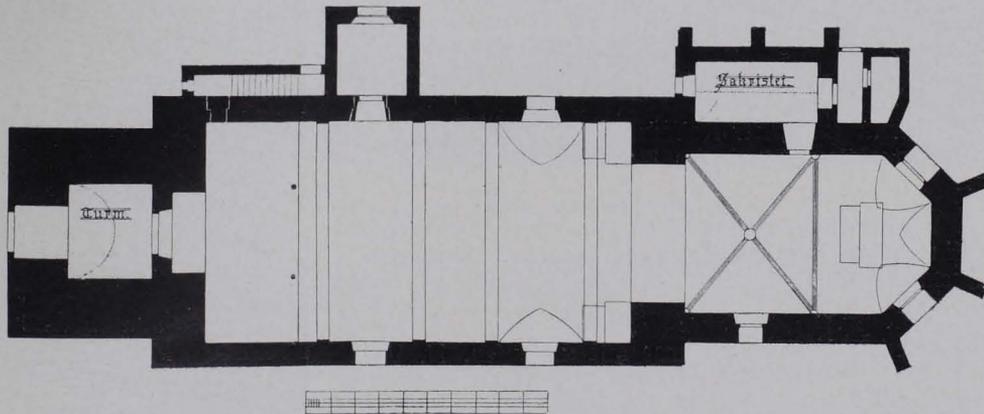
Dobersberg, Pfarrkirche, Grundriß 1 : 300 (S. 2)
